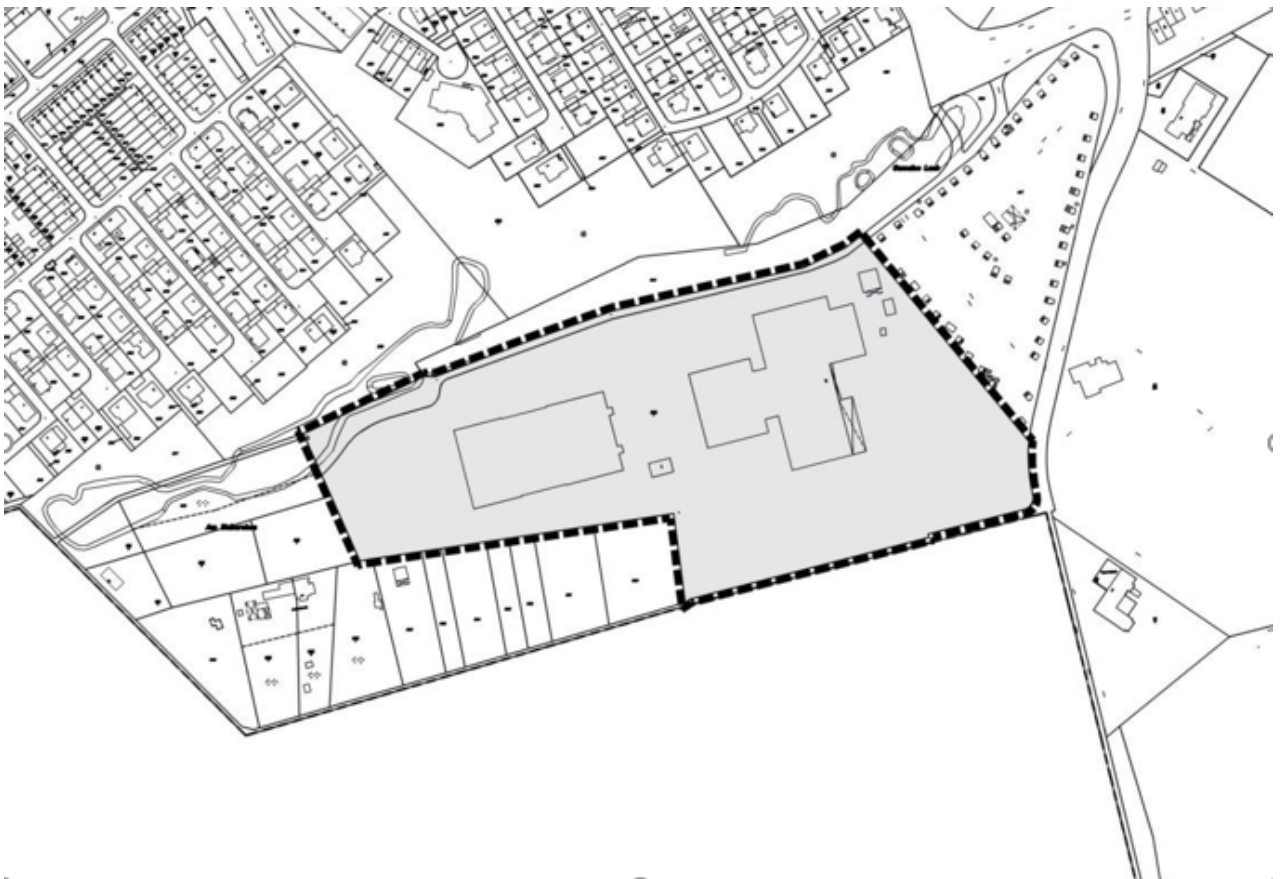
Plangeltungsbereich B-Plan 61.23.17 „An der Lache“ in der Fassung seiner 11. Änderung (o. M.)
